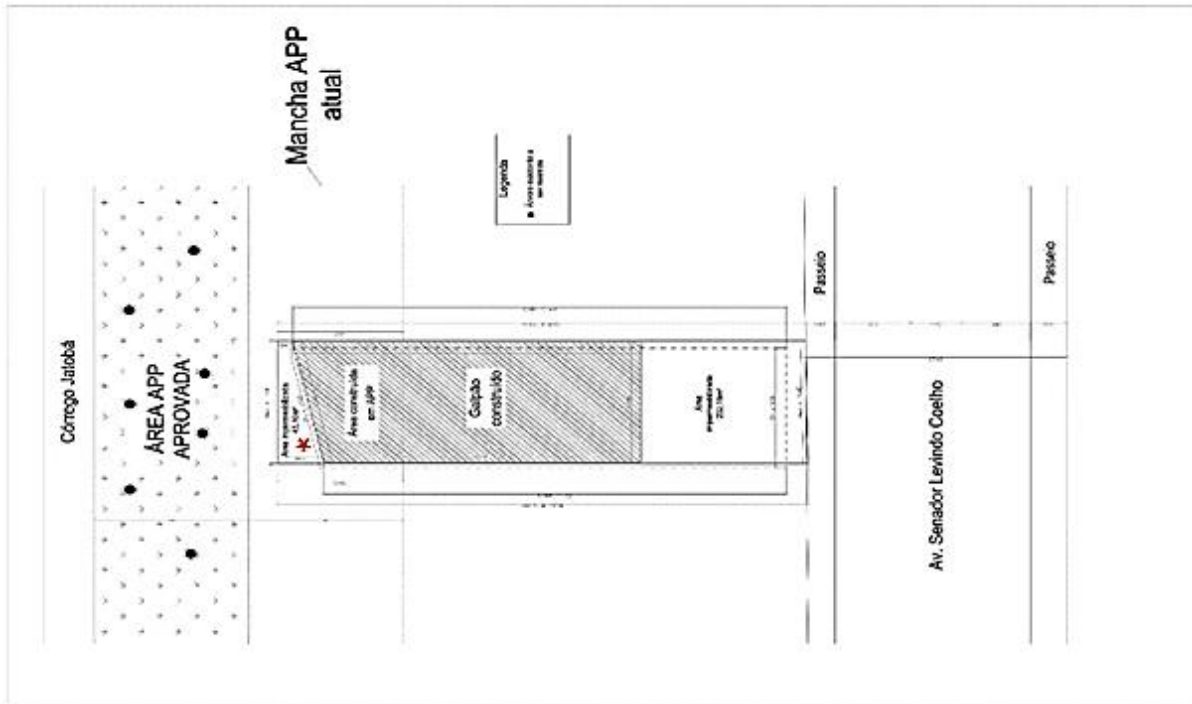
Croqui de Planta de Ocupação da edificação, o asterisco (*) representa área impermeabilizada de 43,1 m² – Adaptado do Protocolo nº 07857/23 (Fonte: Requerente).
